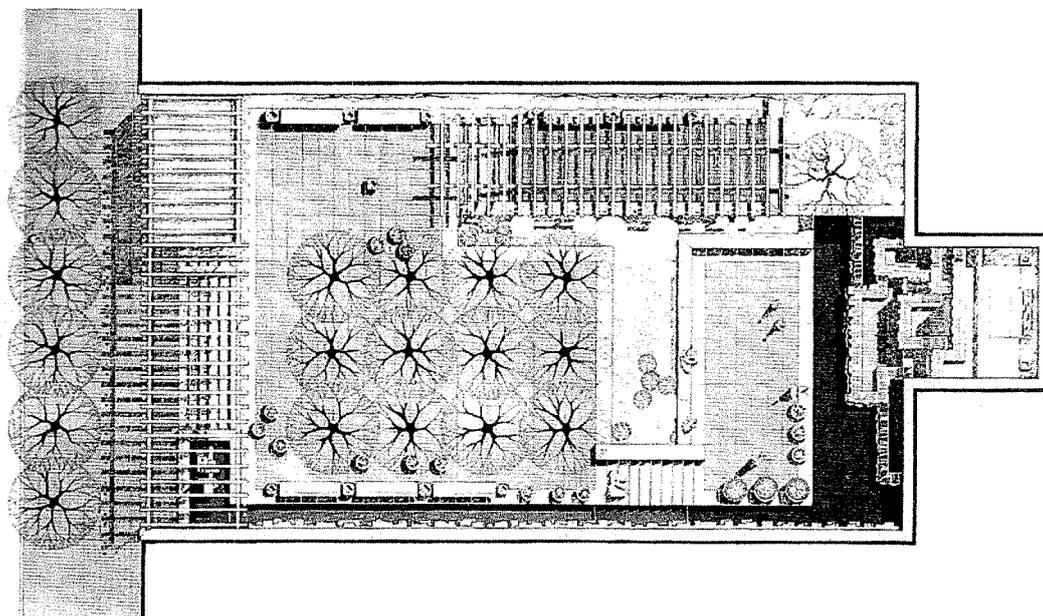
Planta baixa do Greenacre Park , Nova Iorque (Paisagens Úteis, 2006)
